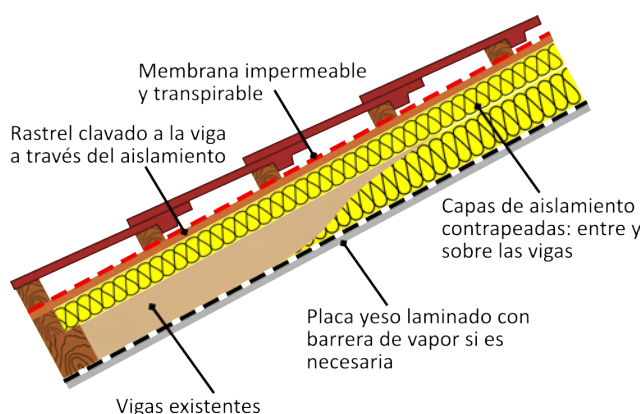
Buena práctica para aislamiento de tejados entre y debajo de las vigas (estructuras ligeras).
